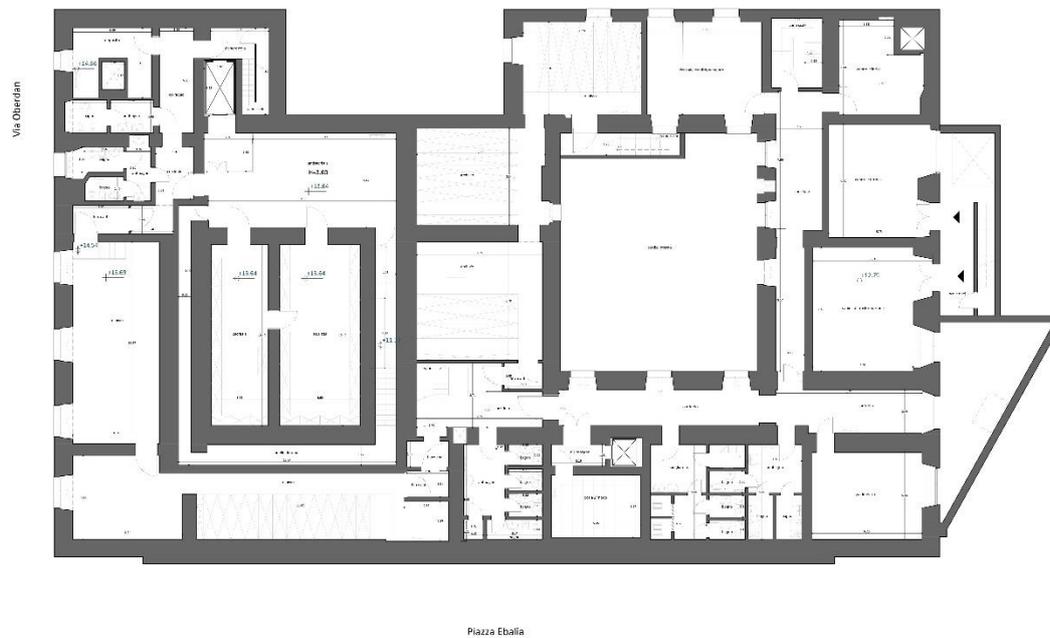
Pianta piano seminterrato. Rilievo architettonico a cura dell'Ing. Giorgio Tonti.
